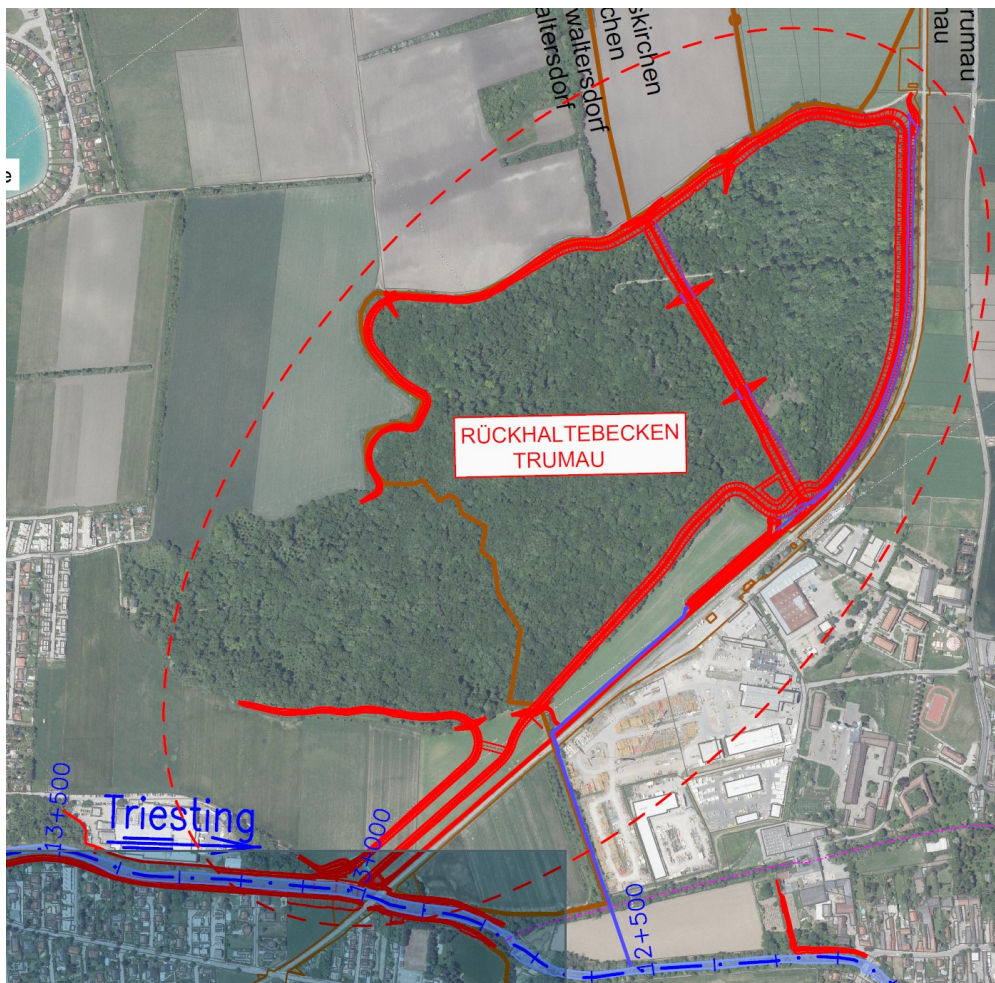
Übersichtslageplan des geplanten Hochwasserrückhaltebeckens Trumau mit Einlaufkanal im Südwesten (Auszug aus
